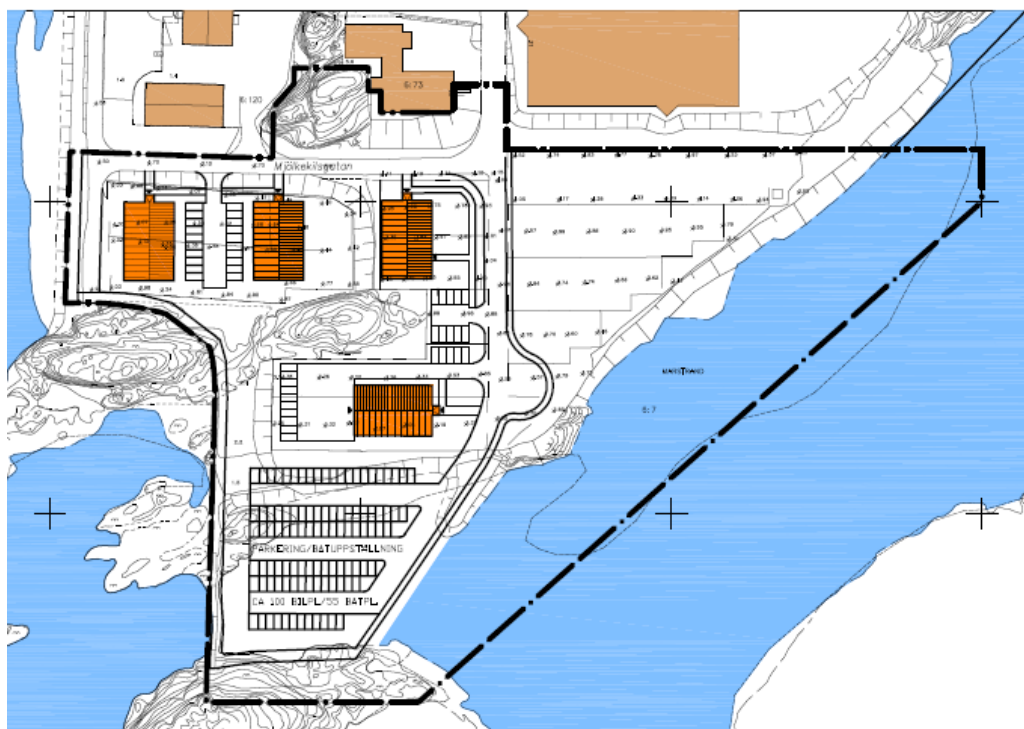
Planförslag över Badhålan/Mjölkekilen.
